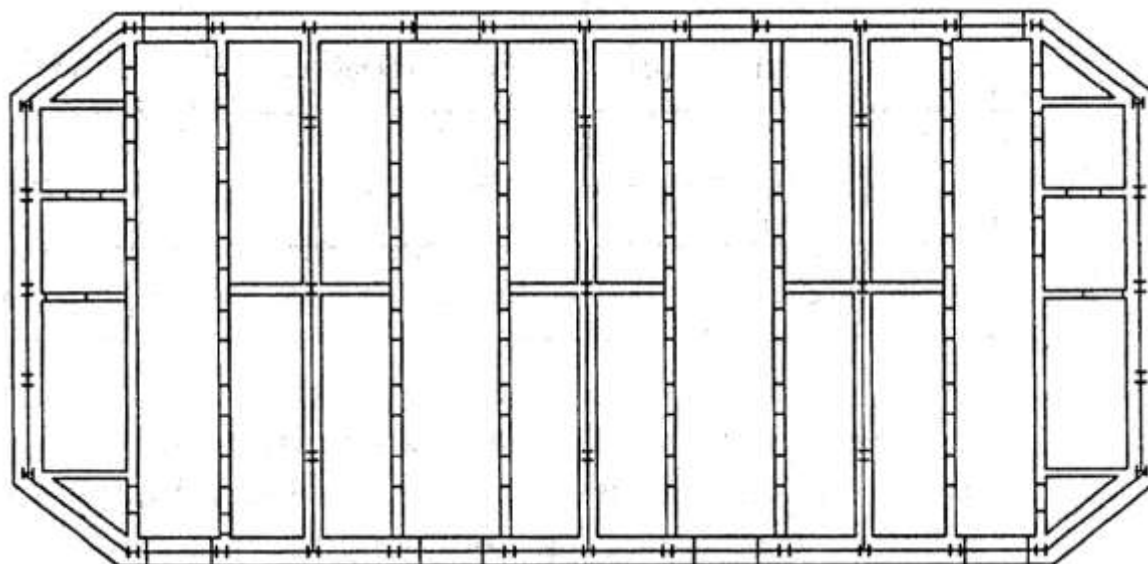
План расположения элементов жесткого армирования из стальных профилей в стенах ствола ядра жесткости выполненного из монолитного железобетона
